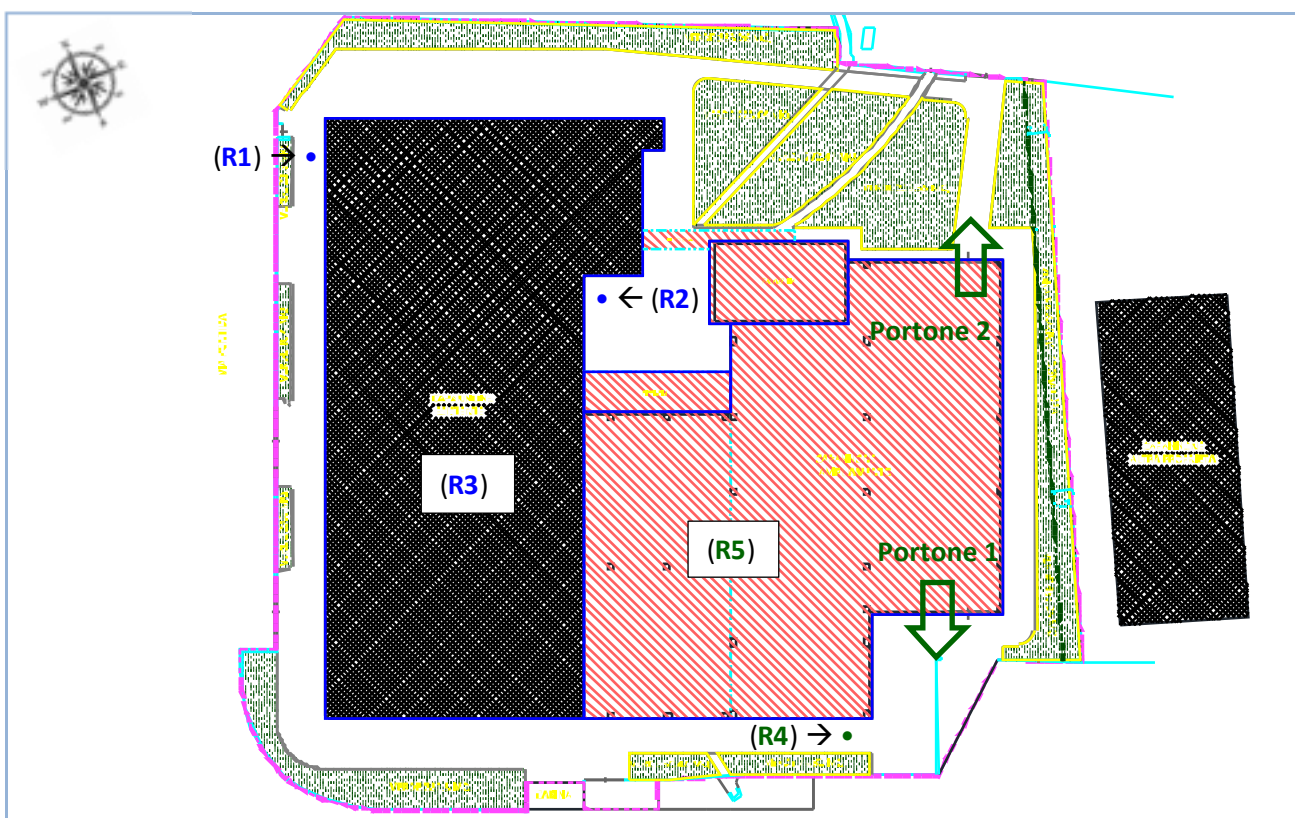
planimetria insediamento con posizione sorgenti sonore
